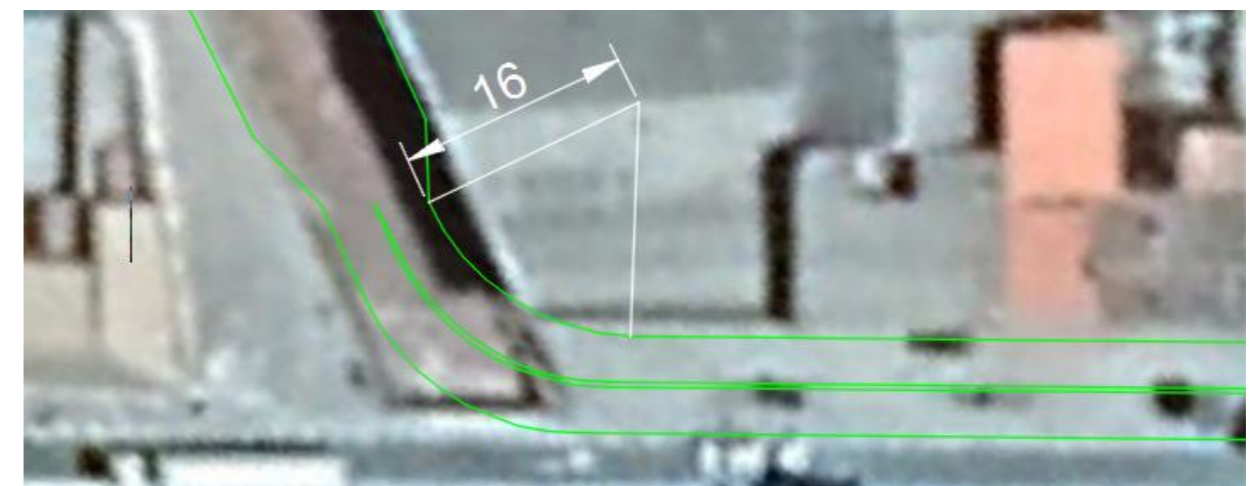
Detalle embocadura en planta. Fuente: Propia.
